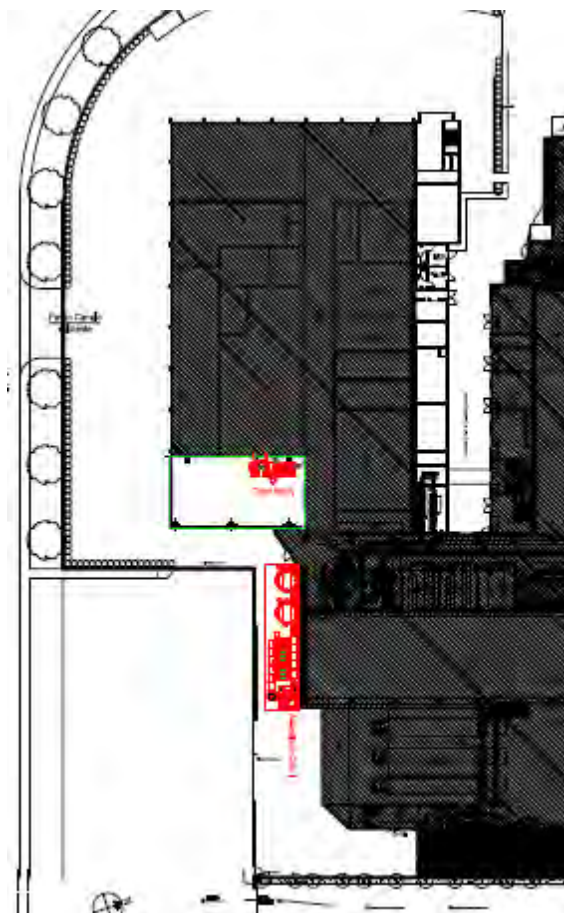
stralcio planimetria con evidenziazione nuovi impianti in rosso
